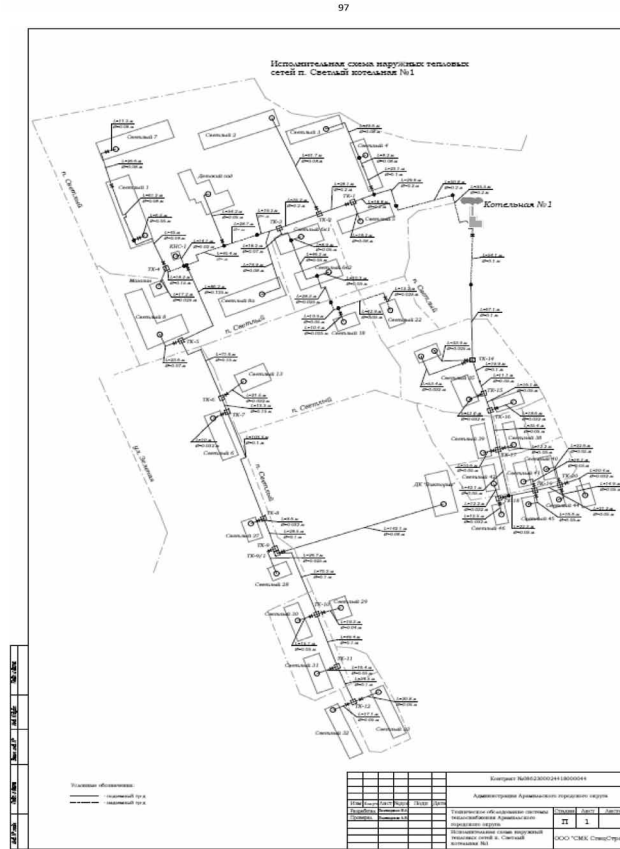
Исполнительная схема наружных тепловых сетей котельной №1
